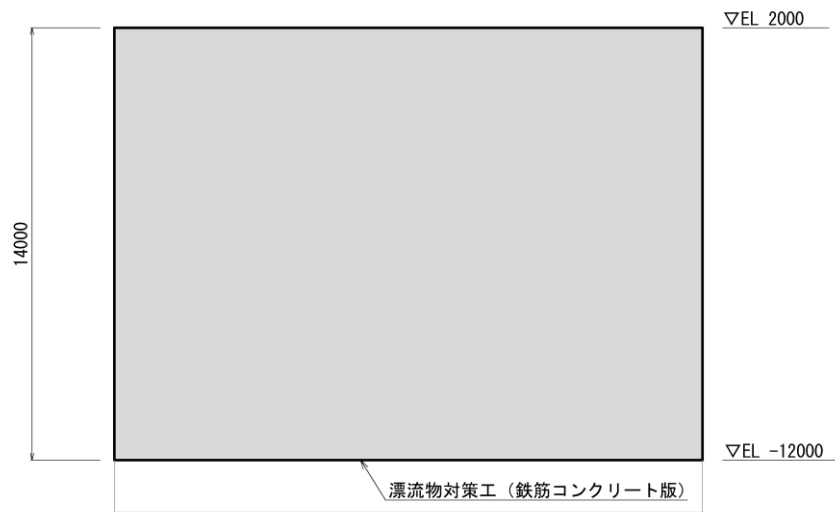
(3) 防波壁 (波返重力擁壁) ケーソンにおける漂流物対策工 (鉄筋コンクリート版) の構造概要図 (正面図)
